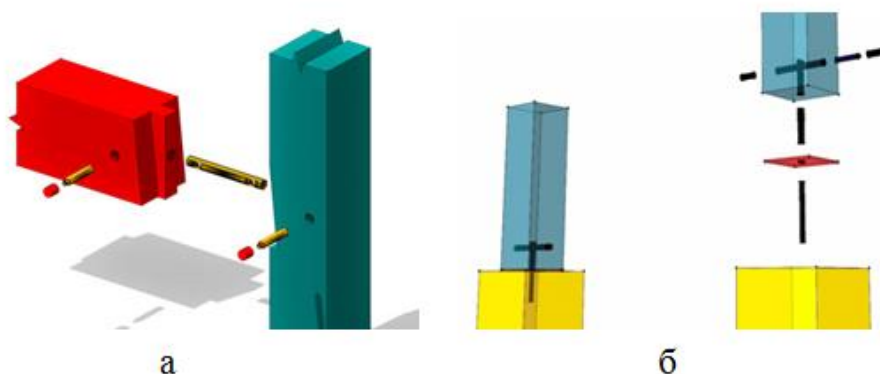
Система TimberLinx: а – соединение ригеля с колонной;
